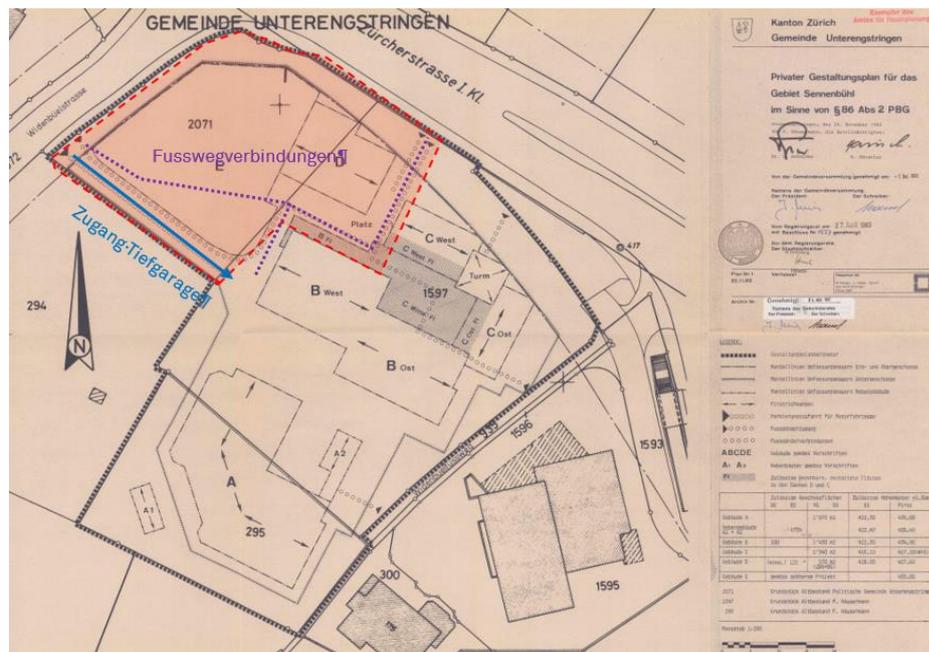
Bestehender privater Gestaltungsplan mit Eintrag der zu sichernden Schnittstellen (Fusswegverbindungen, Zugang Tiefgarage)
